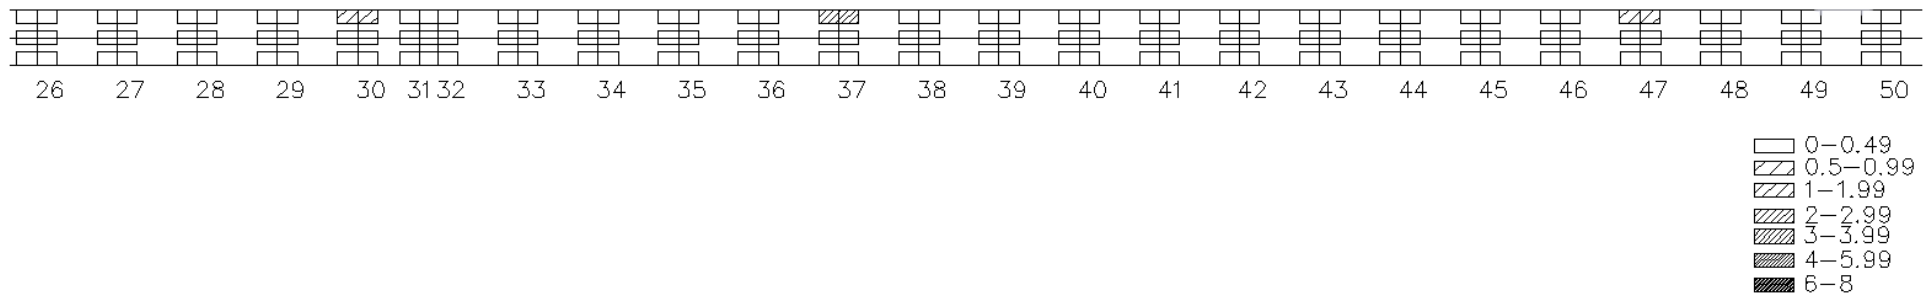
Frästiefen bei kubischer Splinefunktion und Verfahrensplan Typ V, Grundriss, Stationen 26-50
